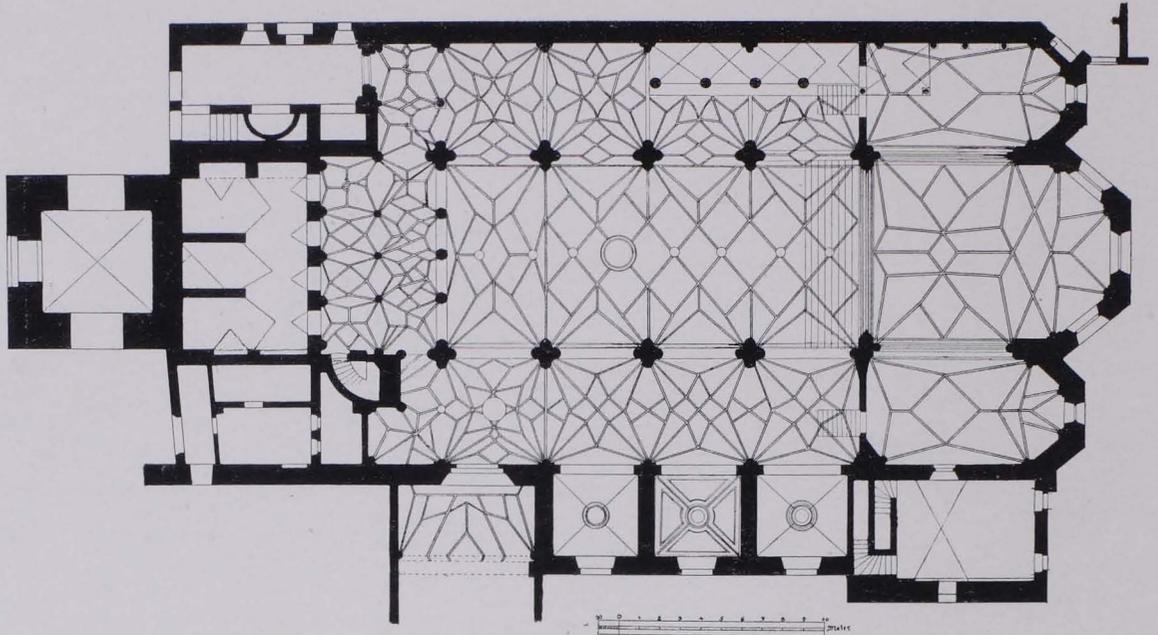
Stiftkirche, Grundriß 1:350 (S. 3)
